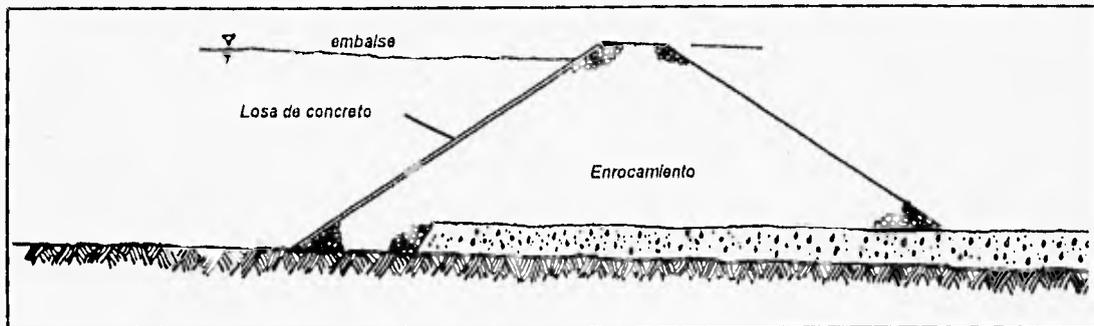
Presa de tierra y enrocamiento con pantalla de concreto aguas arriba.
